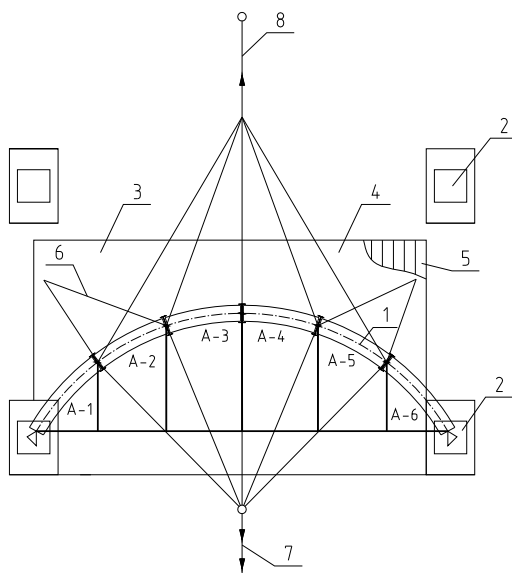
Схема монтажа арок на сплошных подмостях:
